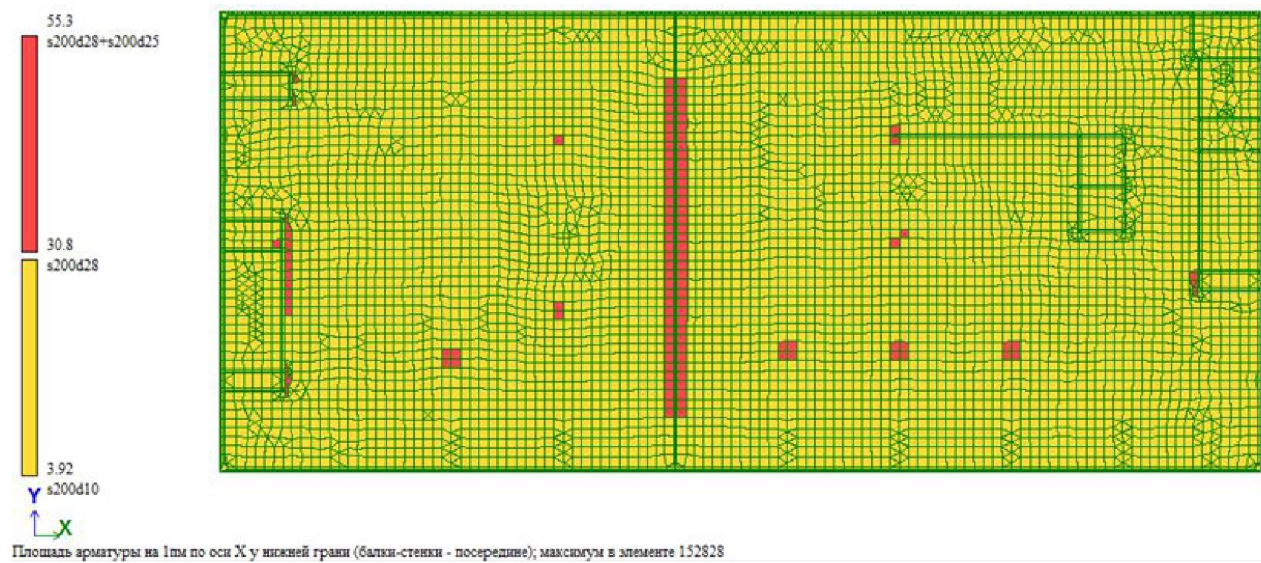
Армования фундаментной плиты (нижне по X)
